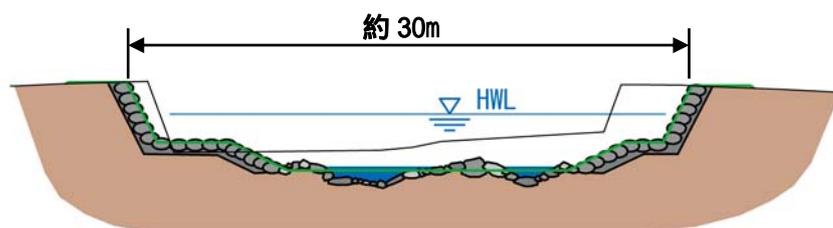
浜川整備計画平面図 (施行の場所、代表断面図)
